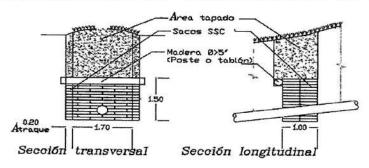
Detalles barreras de sacos suelo-cemento para bajado de tuberías y excavaciones
